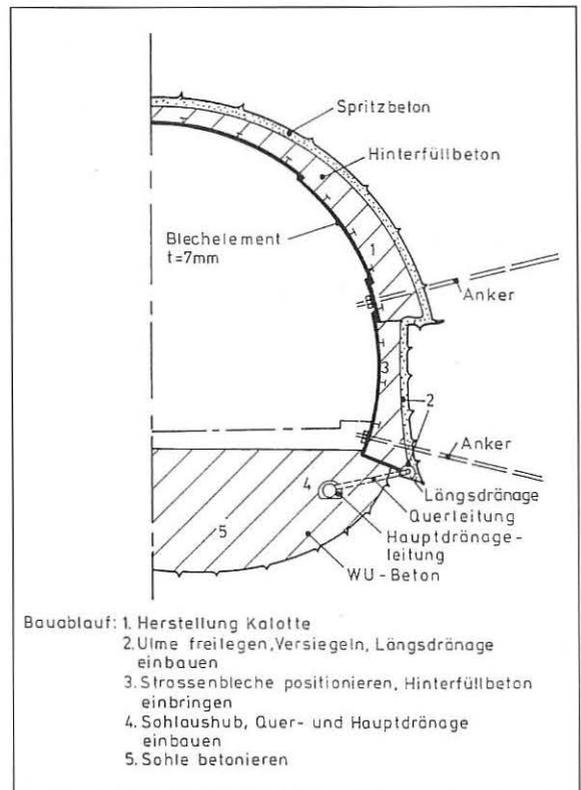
Einschalige Tunnelauskleidung mit Stahlblechelementen
